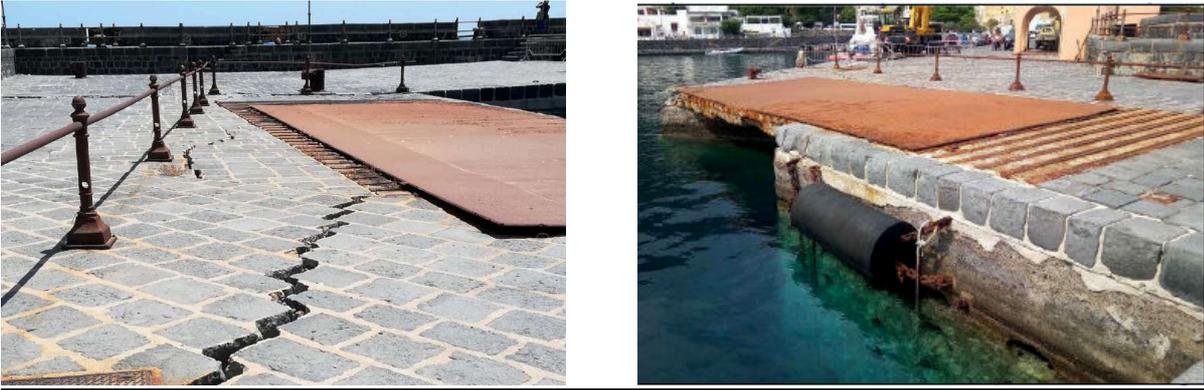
Dettagli dissesto della banchina e fenomeno di svuotamento
